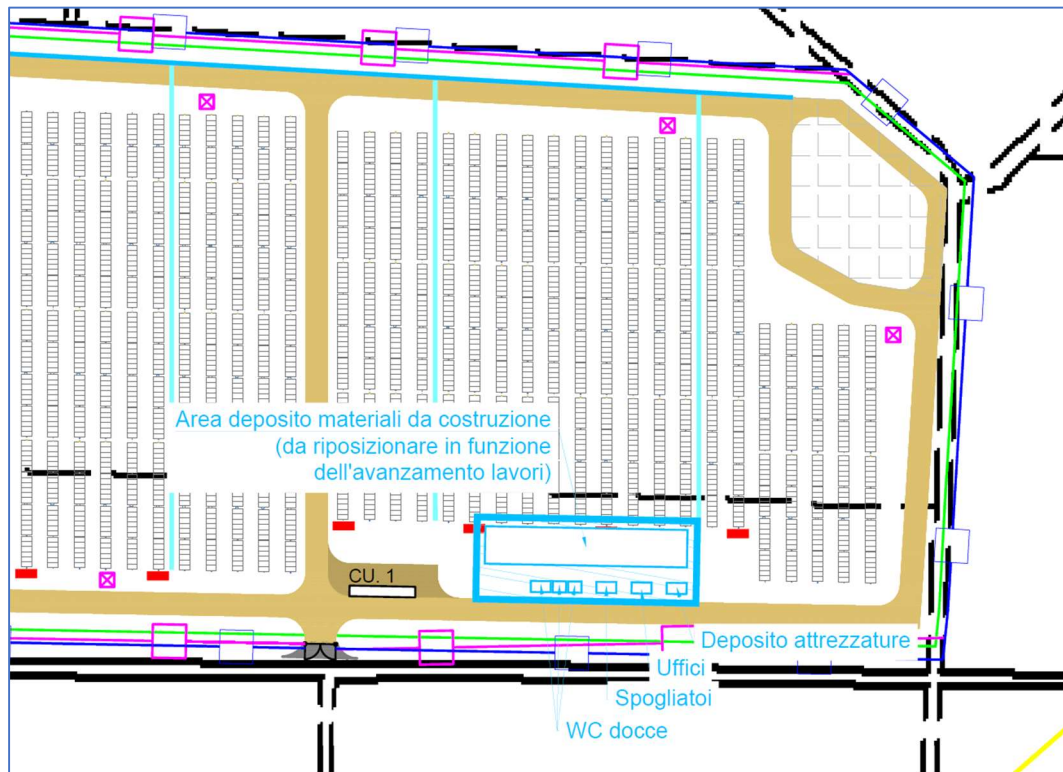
Individuazione delle aree con gli apprestamenti di cantiere (rispettivamente campi NW e NE)
